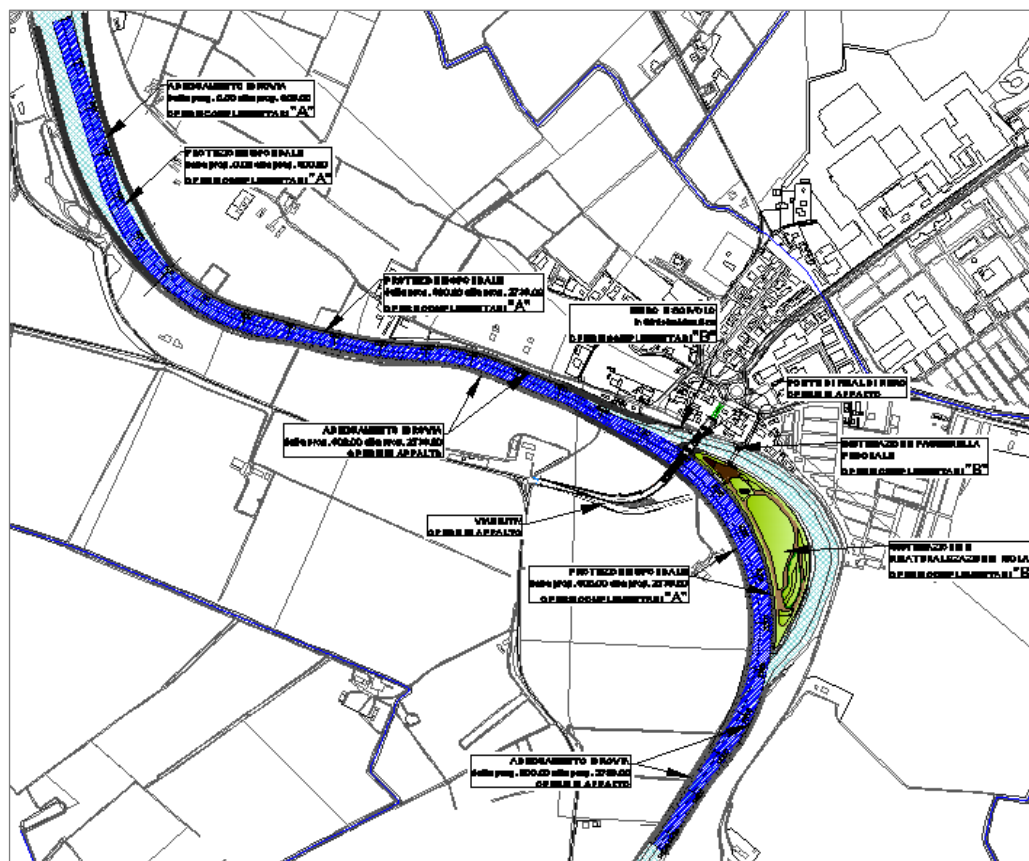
Stralcio planimetrico con evidenza del tratto navigabile oggetto di intervento
